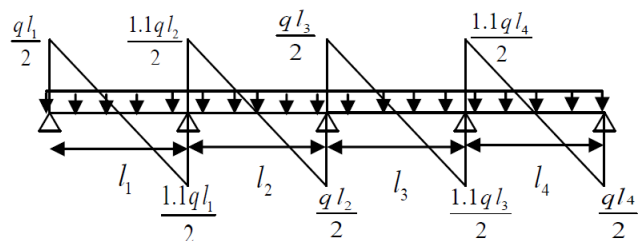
Effort tranchant d'une poutre à plus de 2 travées
